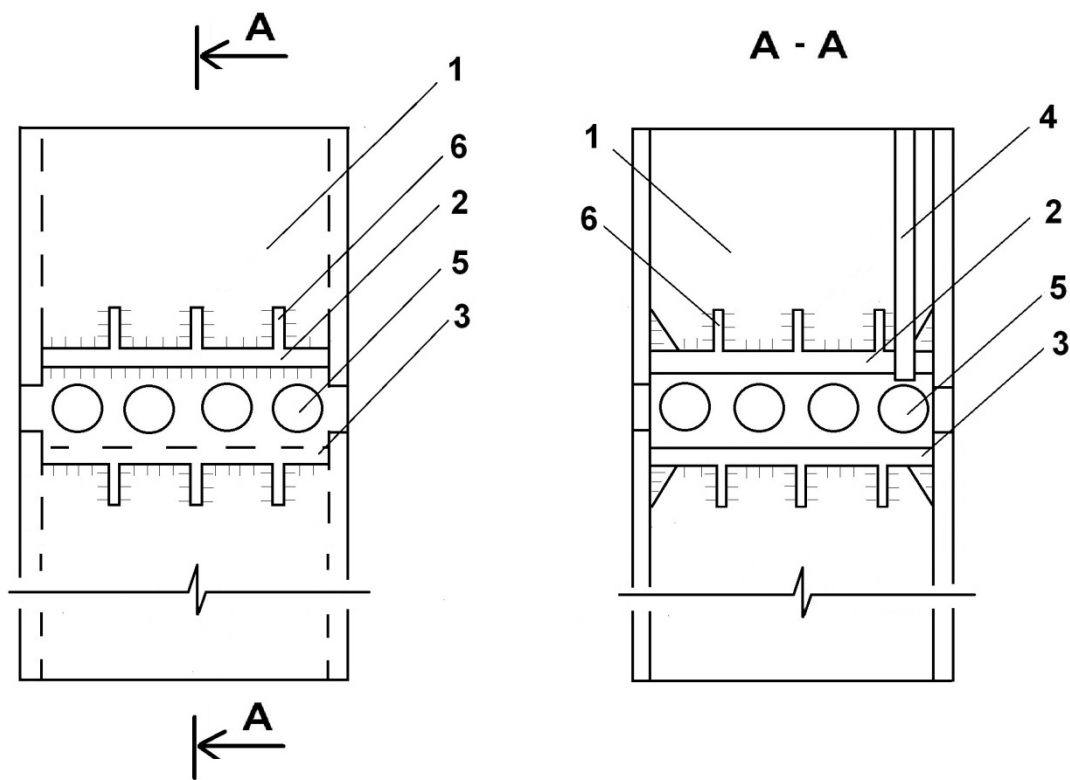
Предлагаемое конструктивное решение сваи: 1 — стенка сваи; 2 — верхняя поперечная диафрагма; 3 — нижняя поперечная диафрагма; 4 — трубка для закачивания цементного раствора в междифрагменное пространство; 5 — отверстия в стенке сваи; 6 — упоры.
